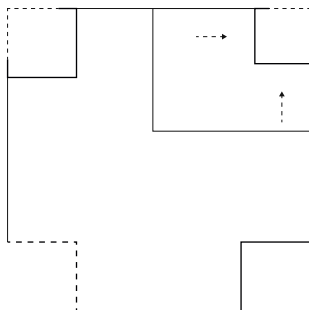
Grundrisskonzeption entsprechend der Raumfigur
